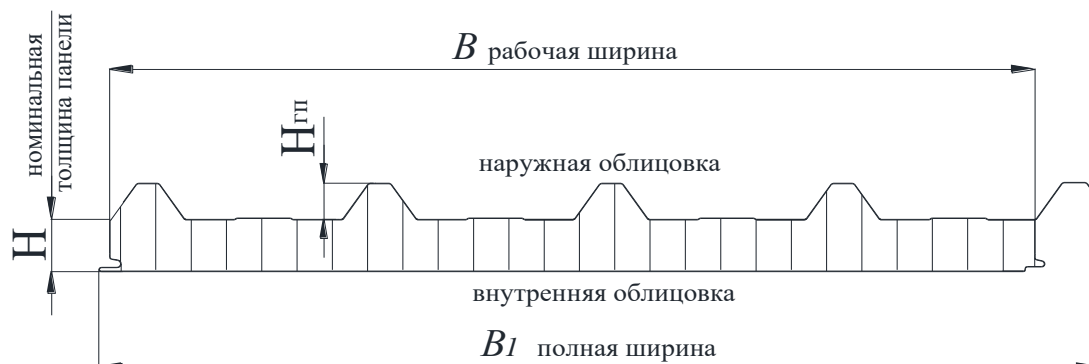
Кровельная панель с глубоким профилированием наружной облицовки
